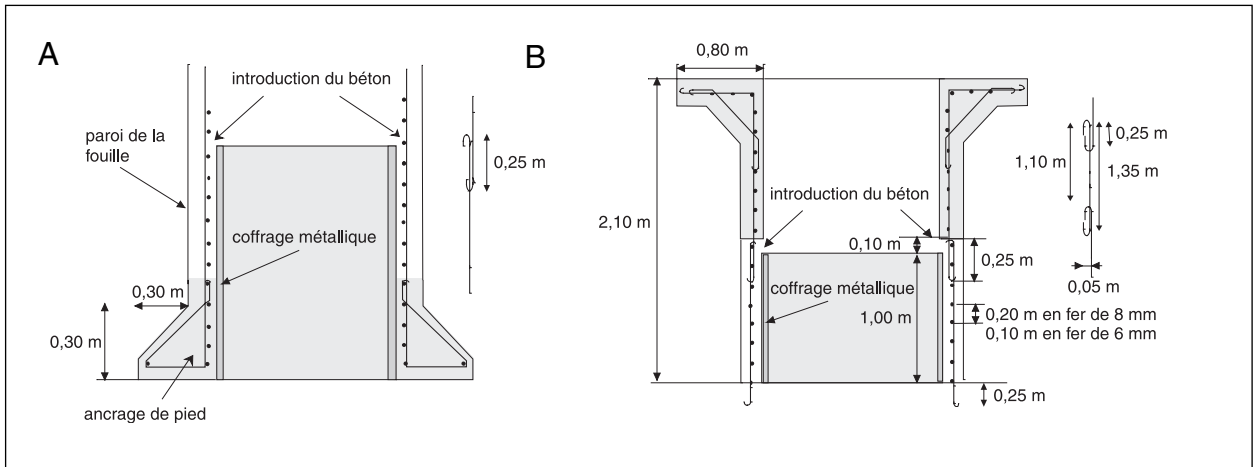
Plan de ferrailage du cuvelage en montant (A) et en descendant (B).
